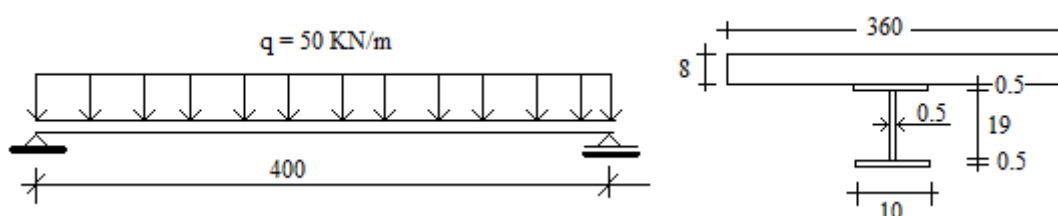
Viga mista e seção transversal (cotas em cm)
